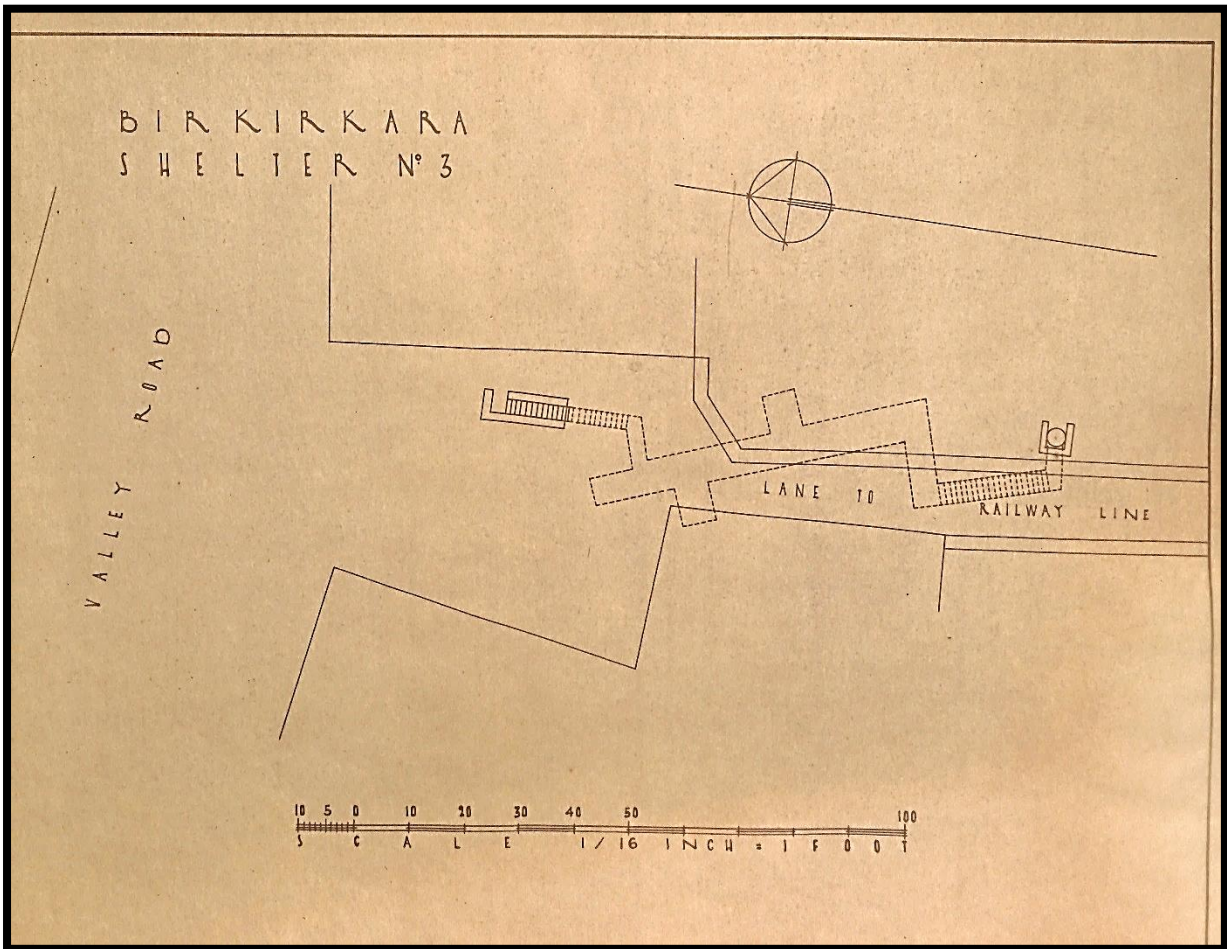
Planta do Abrigo nº3 "Valley Road – Lane to Railway Line."
